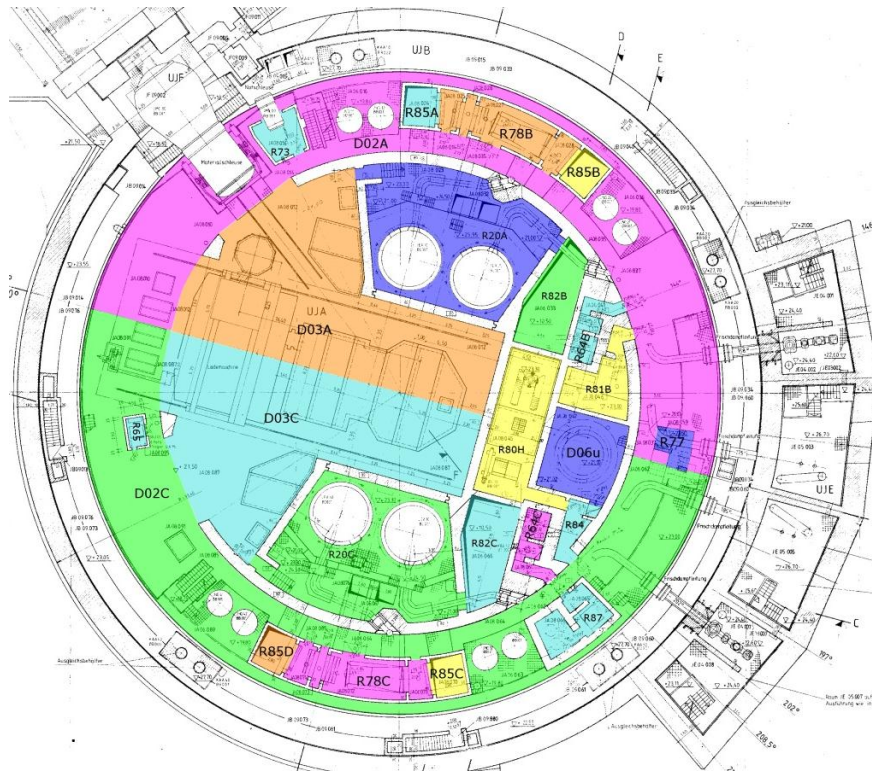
Schnitt durch den SHB bei +21,5 m (Höhenkote +23 m)
